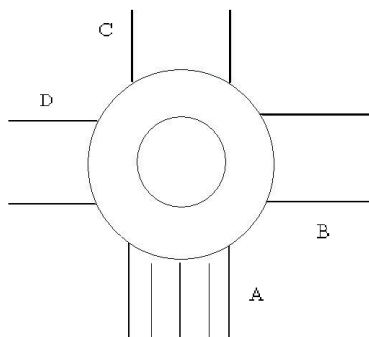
Схема типового коммутатора типа «перекрестка с круговым движением»
